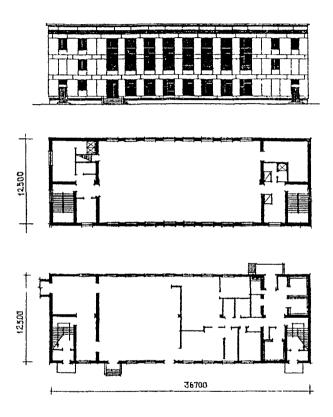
Проект блока-пристройки столовой на 200 посадочных мест и спортзала V-74 (разработан в 1975 году). Фасад и план 1 этажа.
